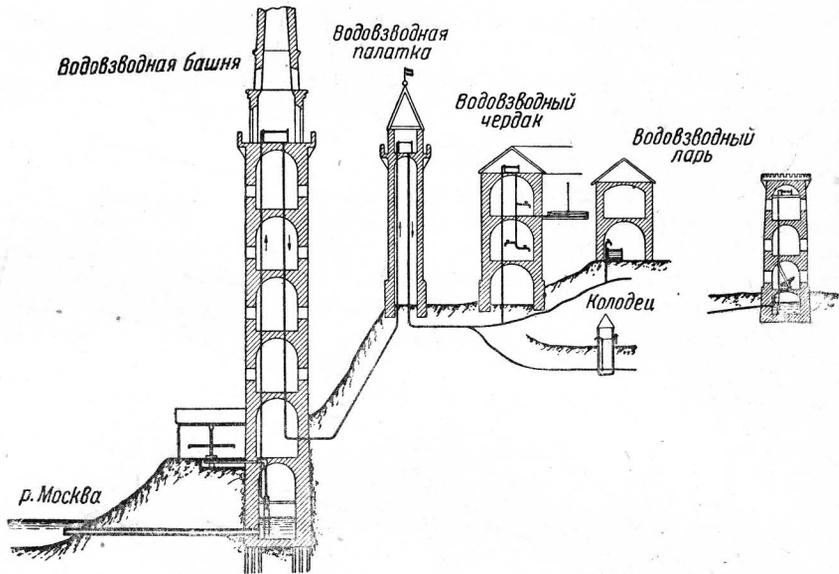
Схема (профиль) водопровода Кремля XVII в. (реконструкция).
